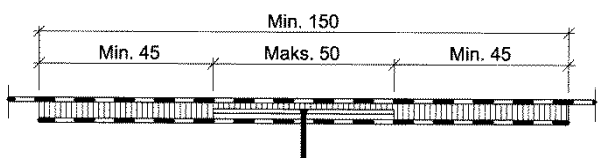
b Bane sveist til underliggende rims mekanisk festet til underlaget
